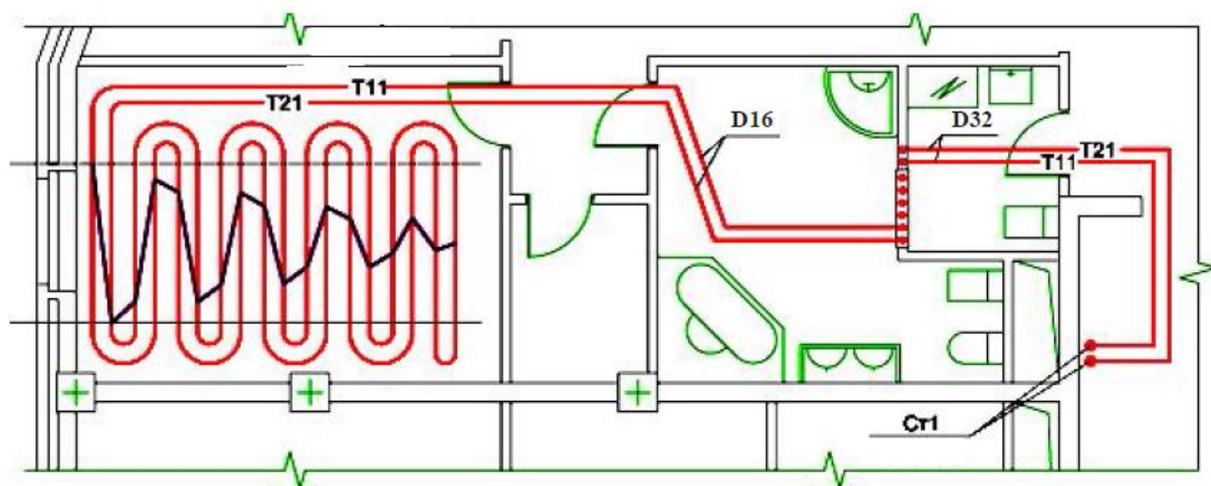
Схема напольного отопления с параллельной укладкой греющих труб
